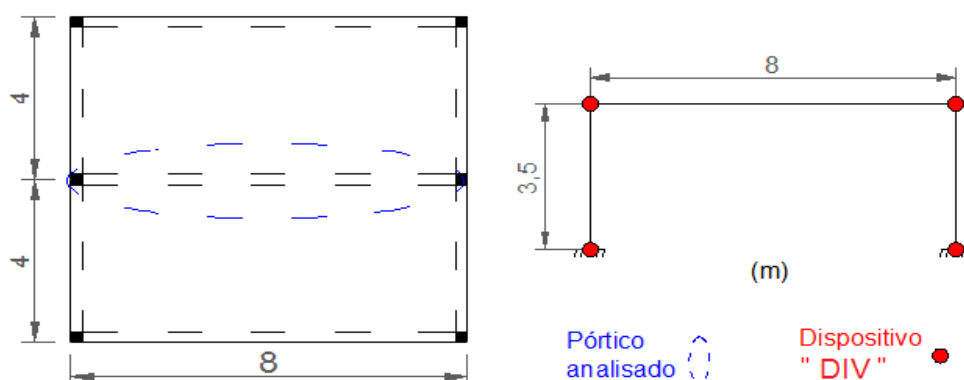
Geometria em planta e alçado do pórtico P1
